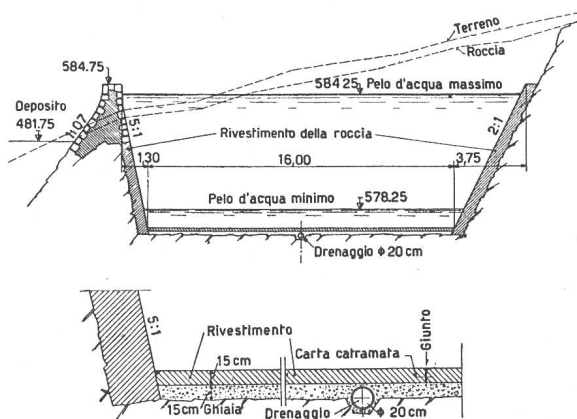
EW Massagno. Ausgleichbecken. Oben: Querschnitt, unten: Detail der Bodenverkleidung.
